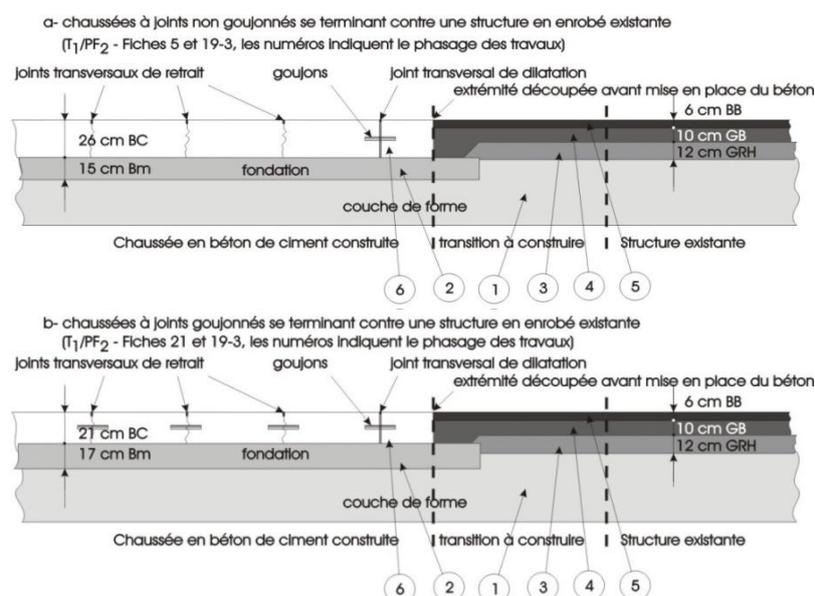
Exemple de deux extrémités de revêtement en dalles sans (en haut) ou avec (en bas) goujons se raccordant sur un revêtement en matériaux bitumineux
